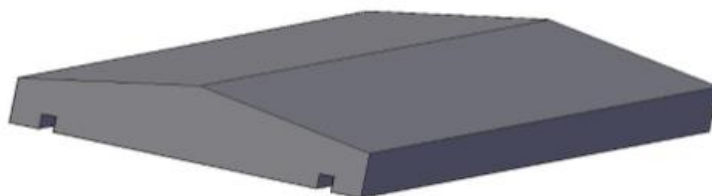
Desenho esquemático do chapim pré-moldado de concreto.
